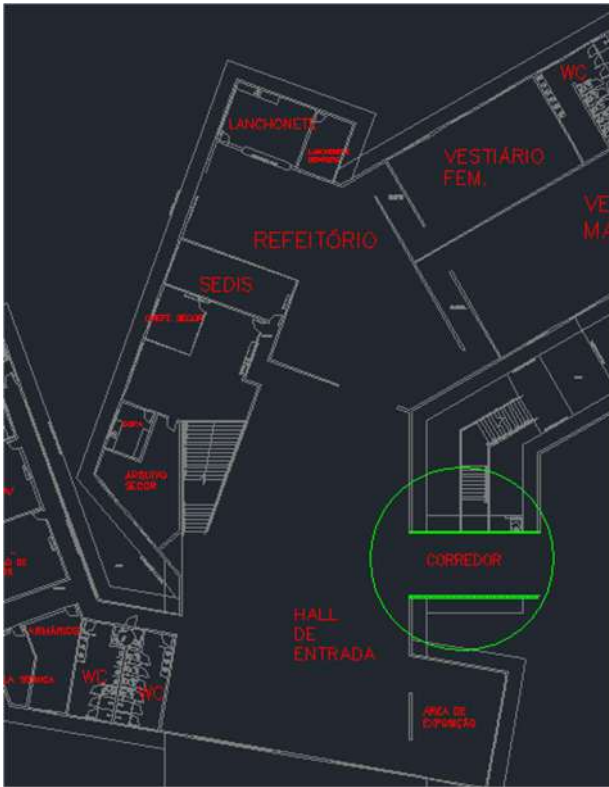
Alvenaria passarela/corredor térreo – Planta baixa Bloco B
